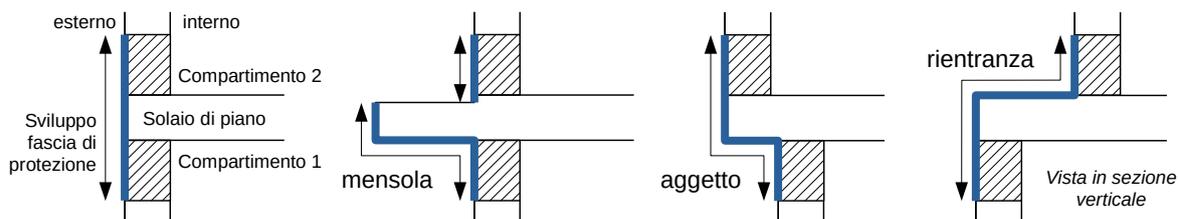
Fascia di separazione orizzontale in facciata
